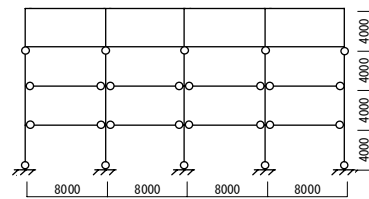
建物モデル概要 (1-3層崩壊, 単位: mm)
